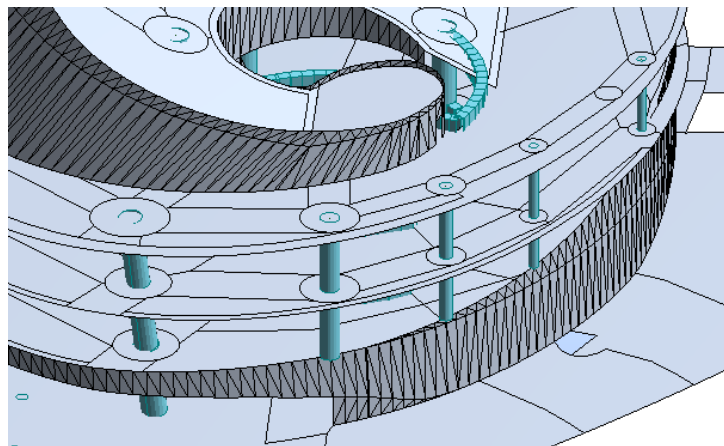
Localização dos pilares que descarregam sobre a lâmina.
